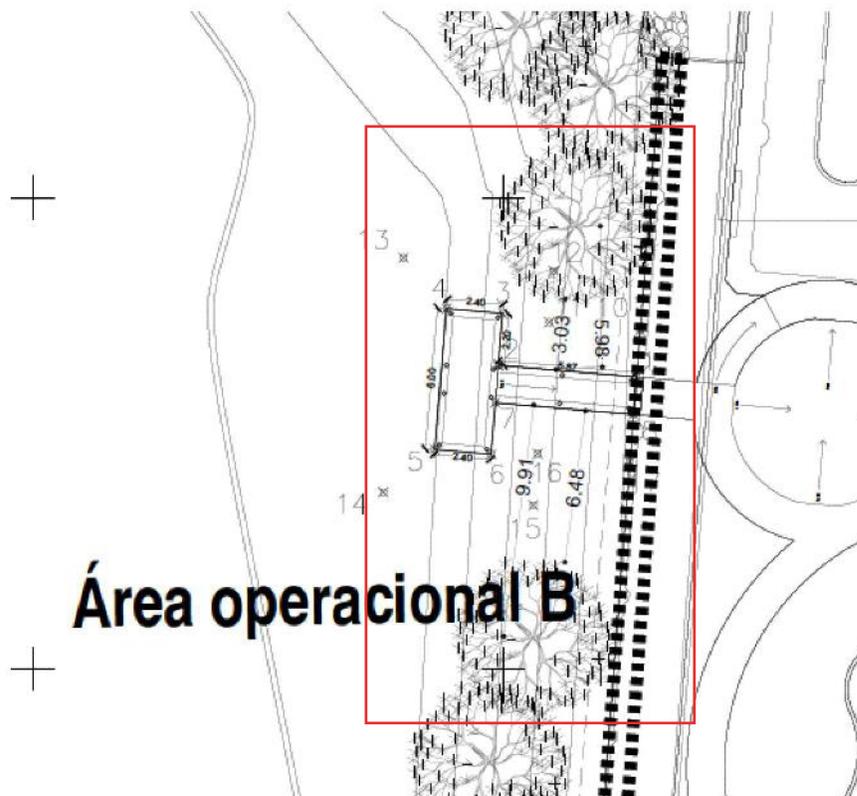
Plano con las proyecciones de mangle de borde del área 02
